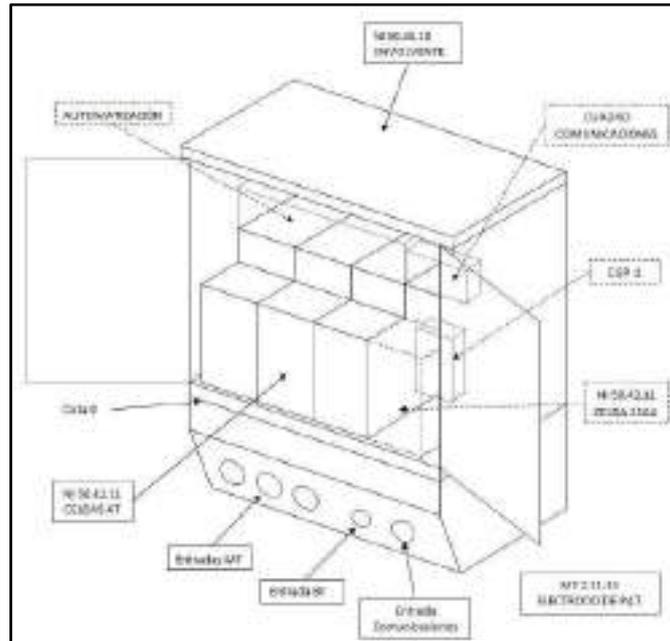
Elementos principales de un centro de seccionamiento tipo.
